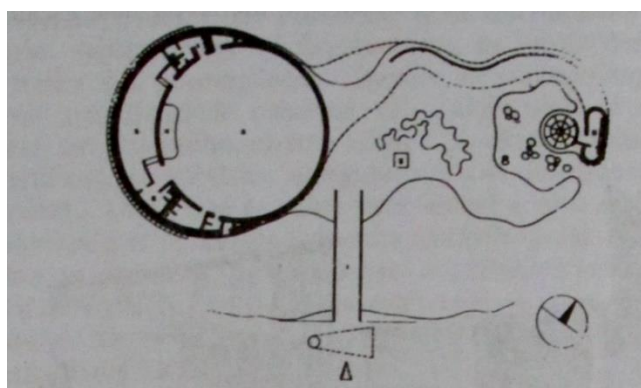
Planta Baixa da Casa de Bailes da Pampulha
